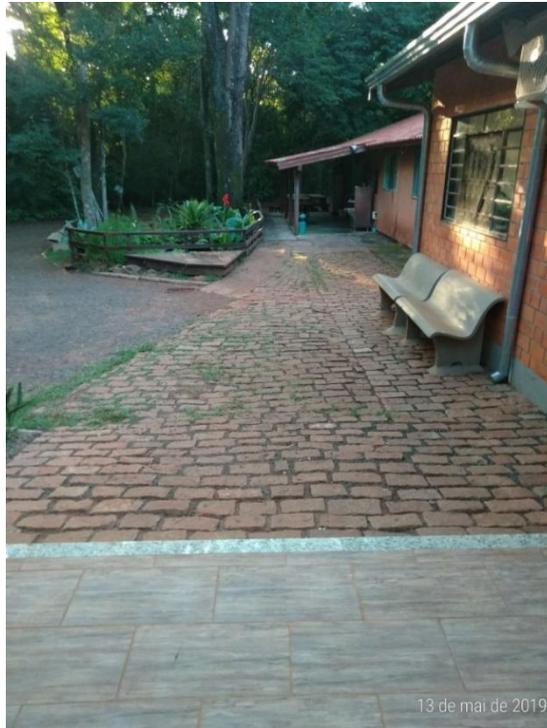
Detalhe do piso de paralelepípedos intermeado de revestimento cimentício que deve ser sobreposto por novo pavimento.
